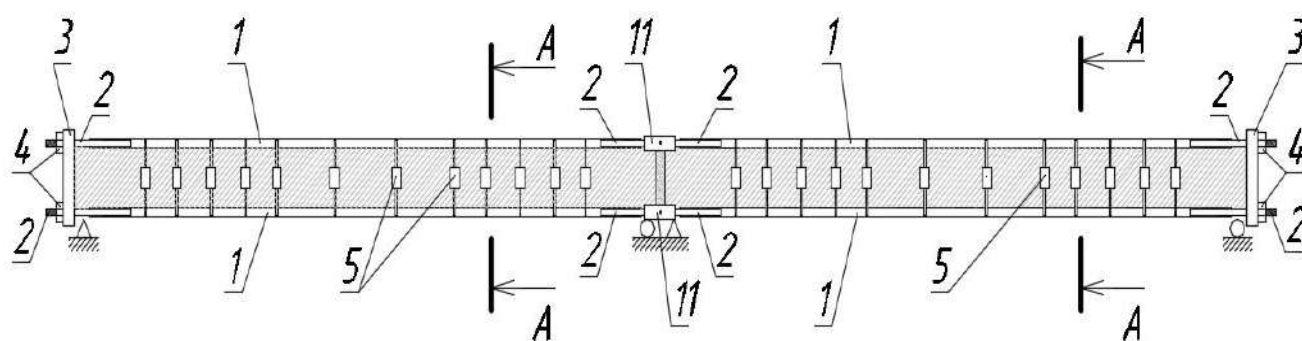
Схема підсилення двох пошкоджених залізобетонних балок
